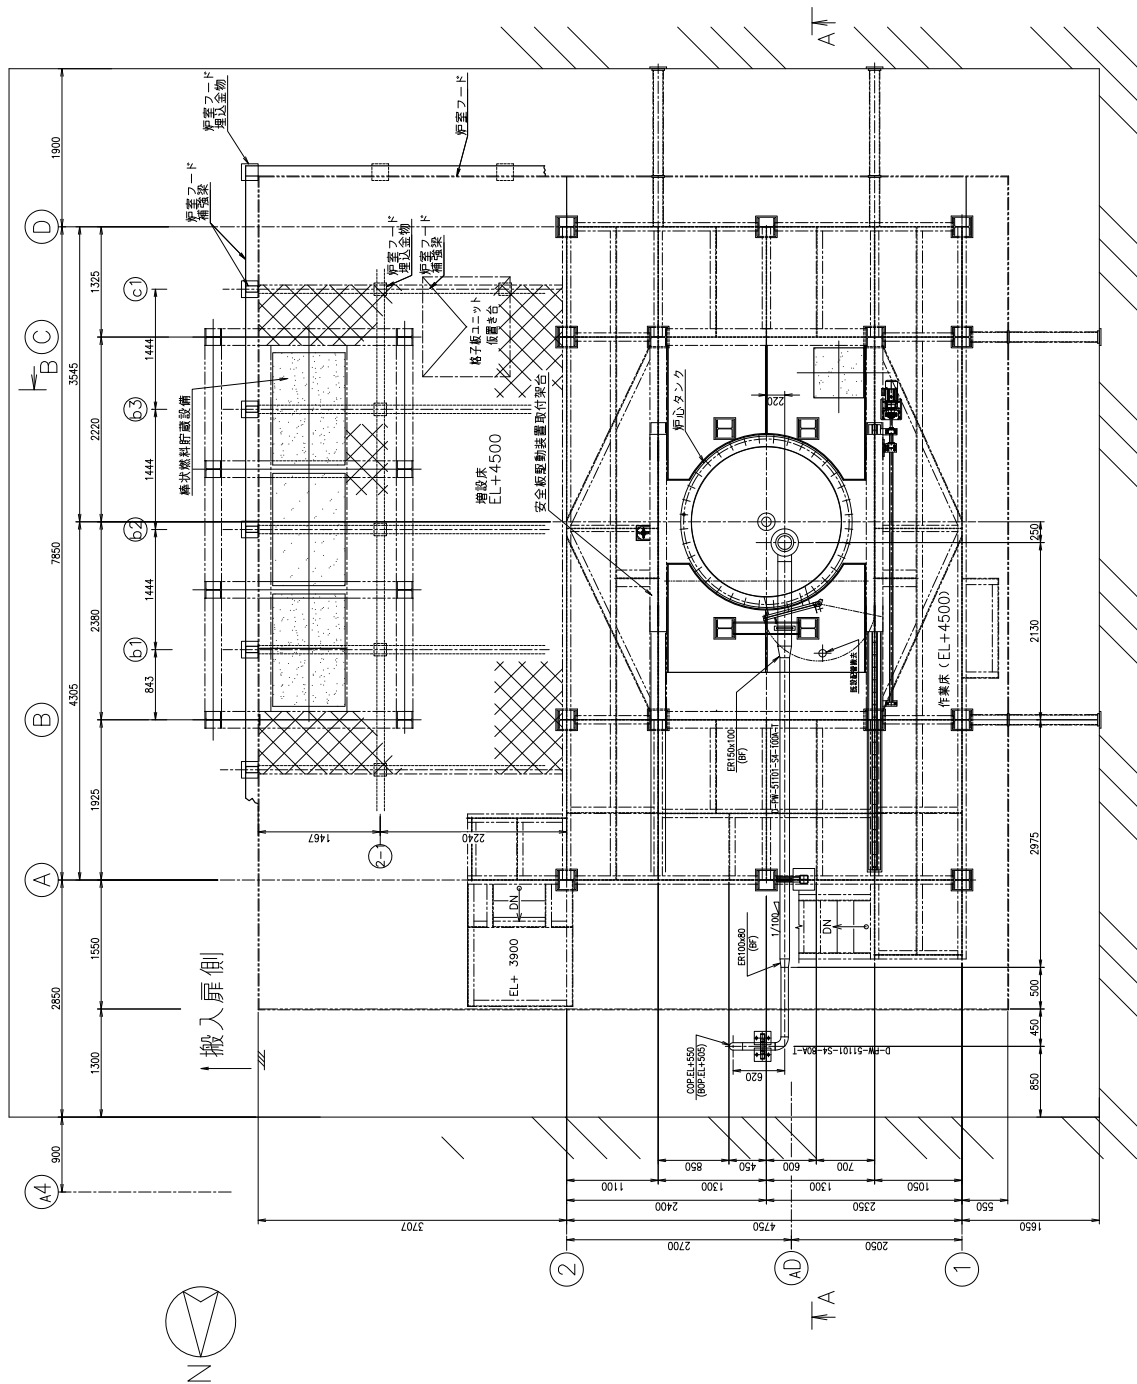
(1) 配管配置図 (炉室(S)平面)
